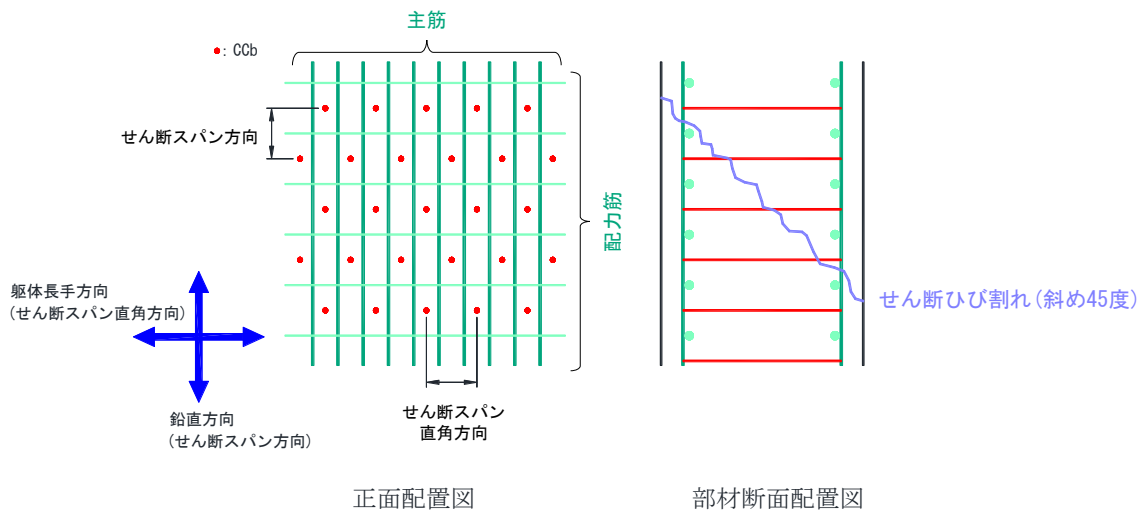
せん断補強筋正面配置図及び部材断面配置図
